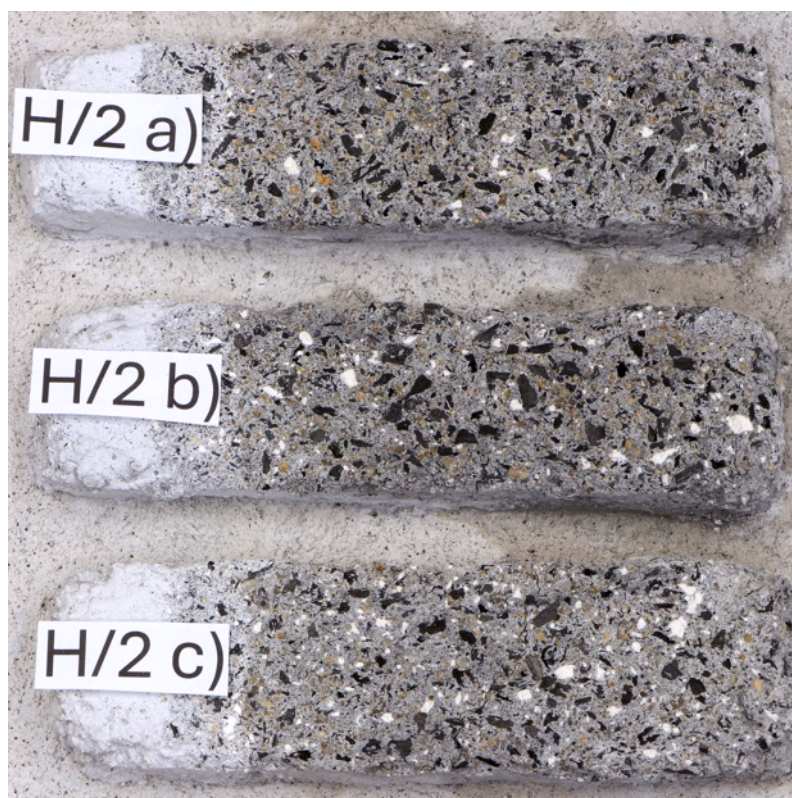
Detail panelu 2, skupina 1 (1:3).
